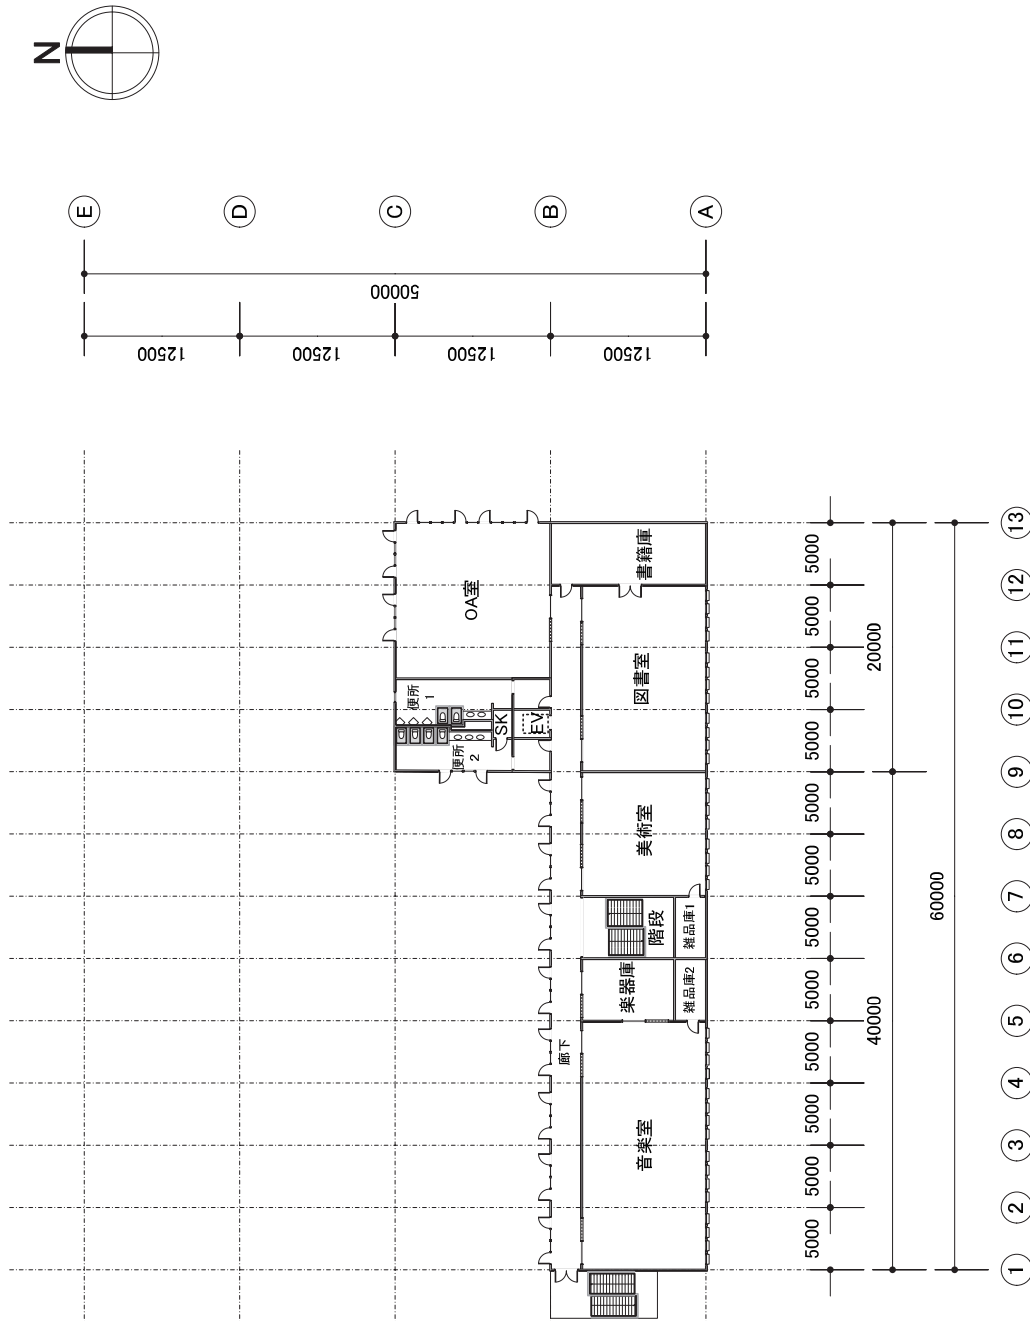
モデル建物 (学校等、5,000㎡) 3階平面図
